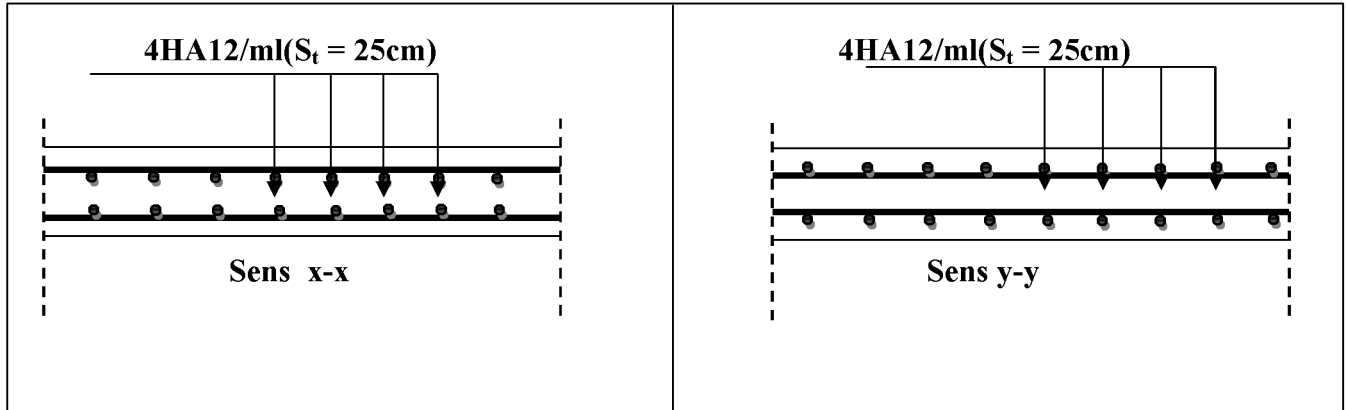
Ferrailage de la dalle pleine de la salle machine en travée.
